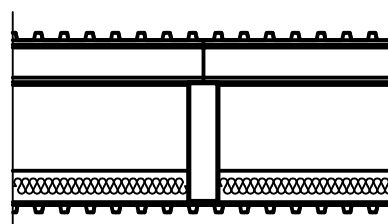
# DETAIL STŘEŠNÍ KONSTRUKCE: M.: 1:20
